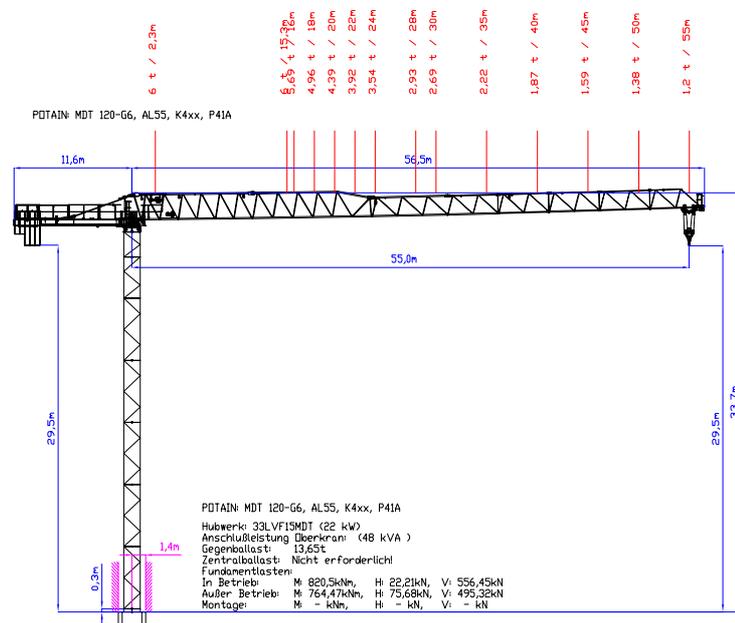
Oben drehender Katzausleger in der Seitenansicht
